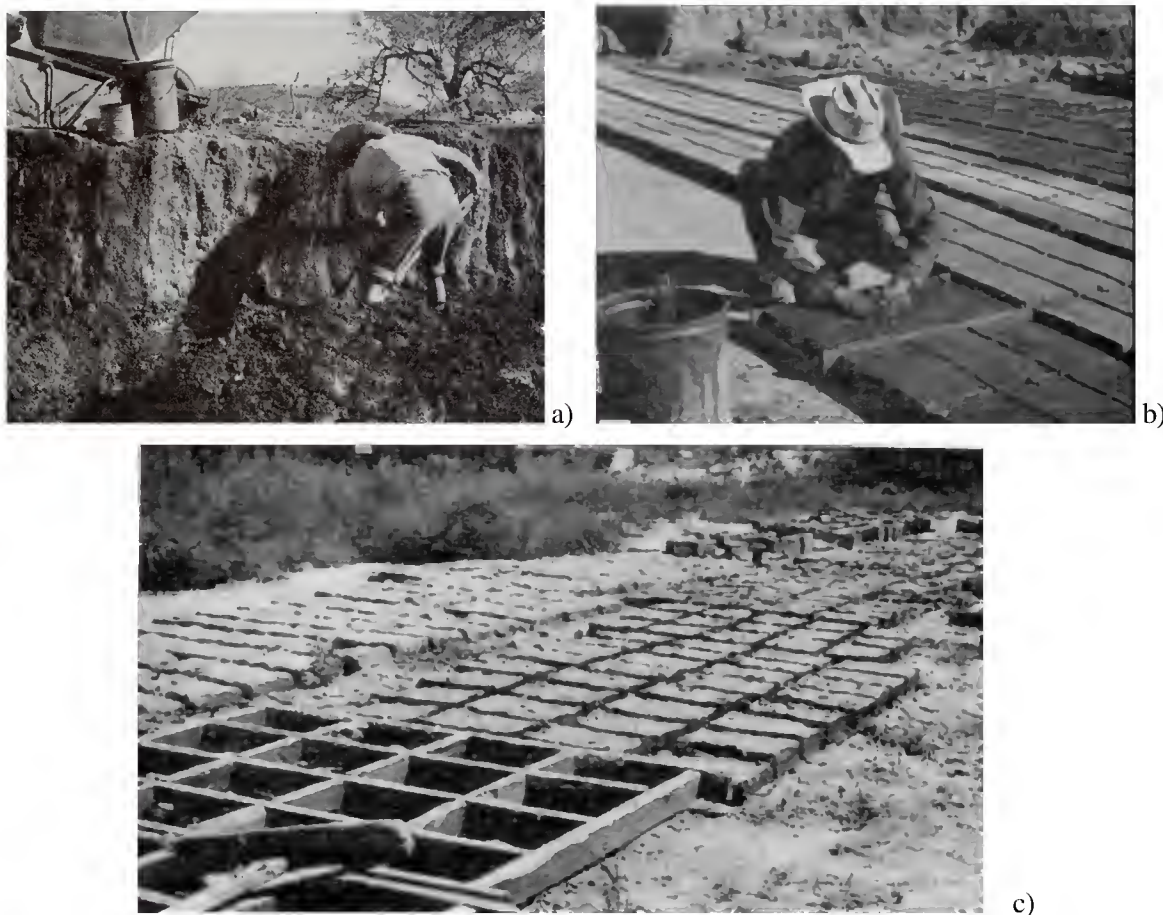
Elaboración de adobes: a) obtención de tierra, b) llenado de moldes c) desmolde y secado de adobes
